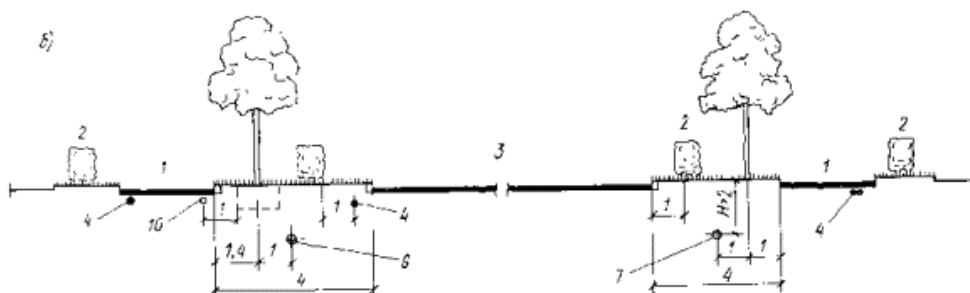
Пример размещения зеленых насаждений и городских подземных сетей в поперечном профиле улиц местного значения: 1 – тротуар; 2 – газон; 3 – проезжая часть; 4 – электрокабели; 5 – газопровод; 6 – водопровод; 7 – водосточный трубопровод; 8 – канализационный коллектор; 9 – общий коллектор; 10 – телефонная канализация [в соответствии с Руководством по проектированию городских улиц и дорог. – М.: Стройиздат, 1980]
